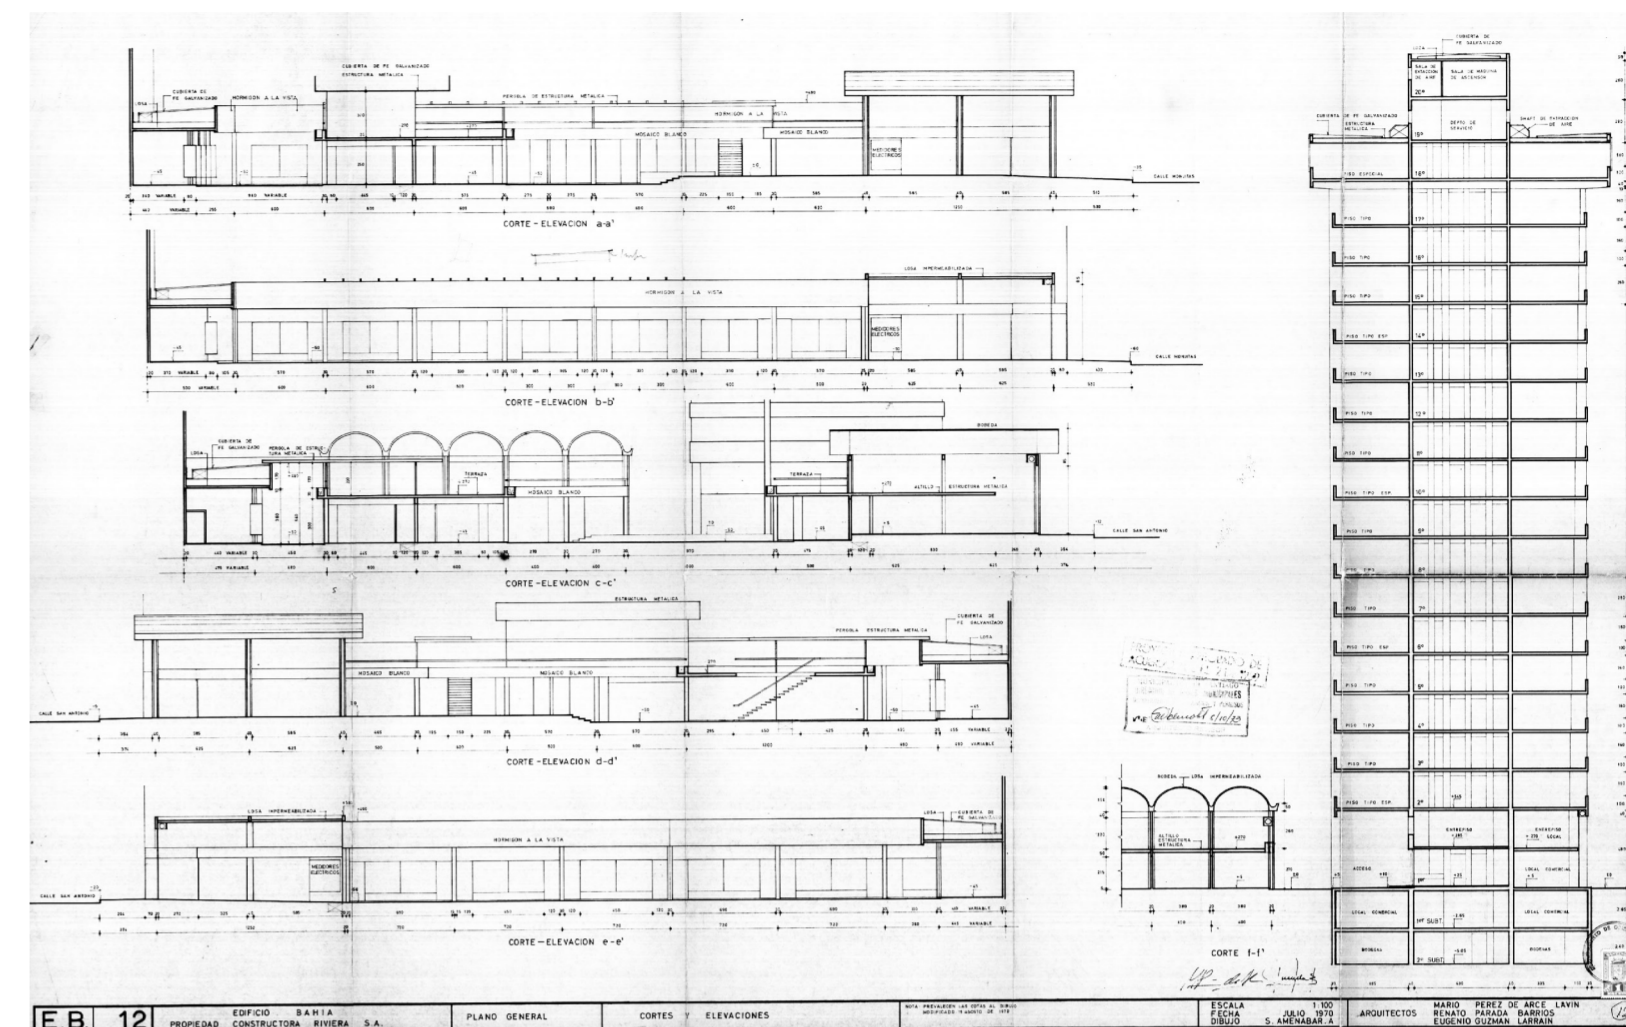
Archivo Plano Municipal. Cortes generales.
